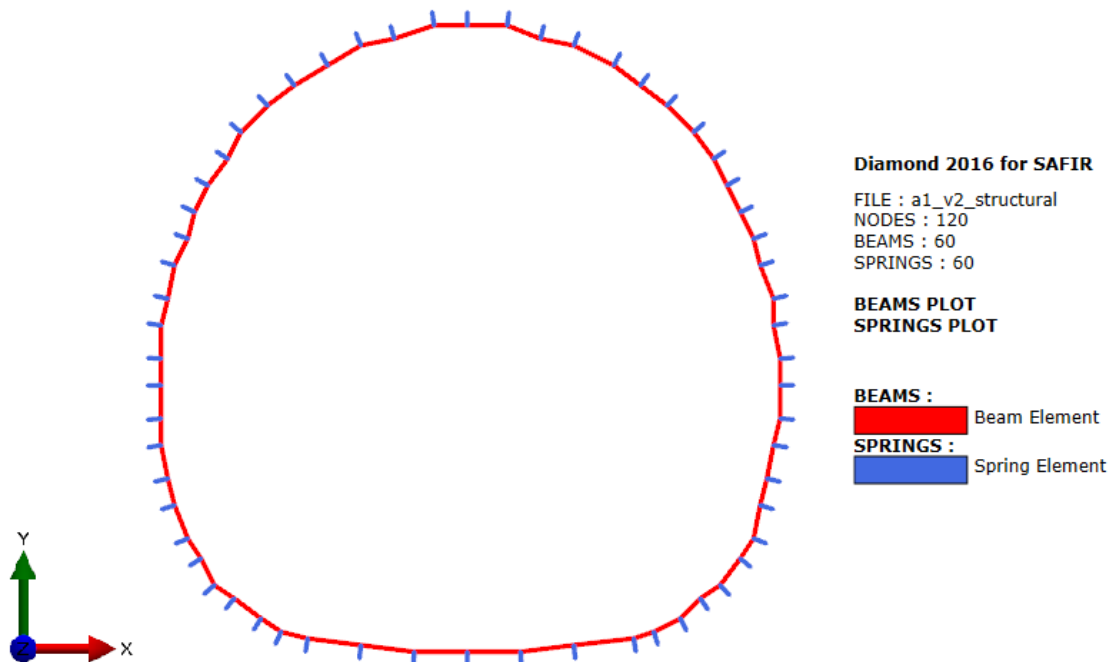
Sezione A1 rappresentata tramite elementi 'beam'
